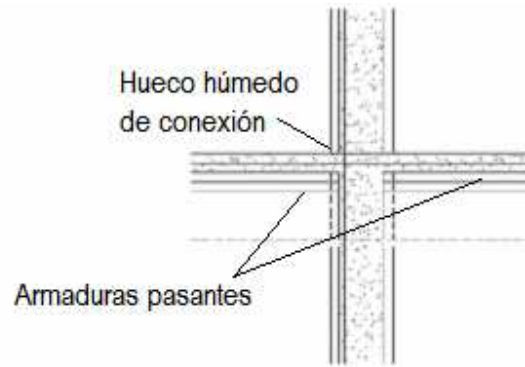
Unión de elementos lineales. Detalle del nudo de conexión húmedo¹⁷ con armaduras pasantes a través del hueco del pilar y la capa de compresión encima de las losas de forjado.
